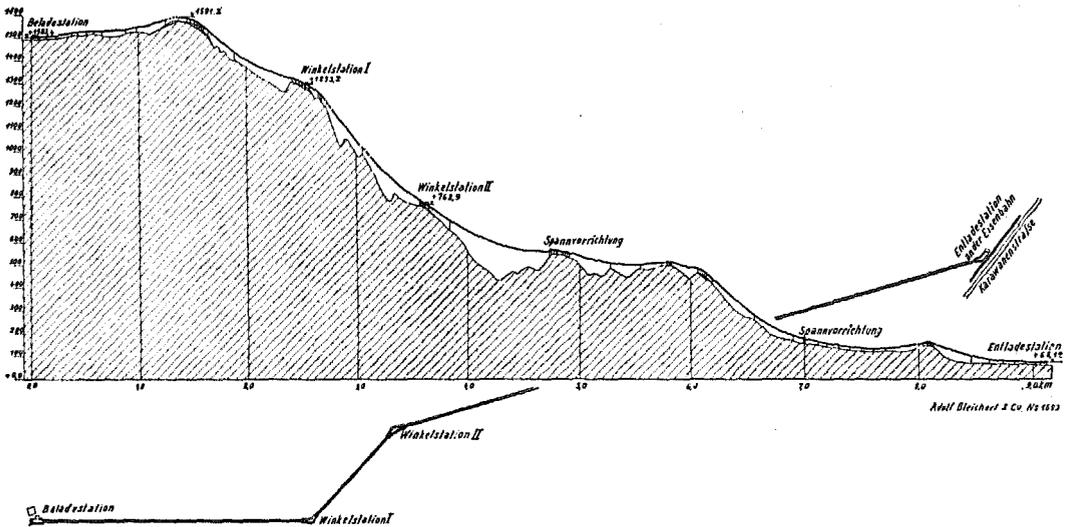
Längsprofil und Grundriß der Drahtseilbahn Mkumbara Neu-Hornow.
